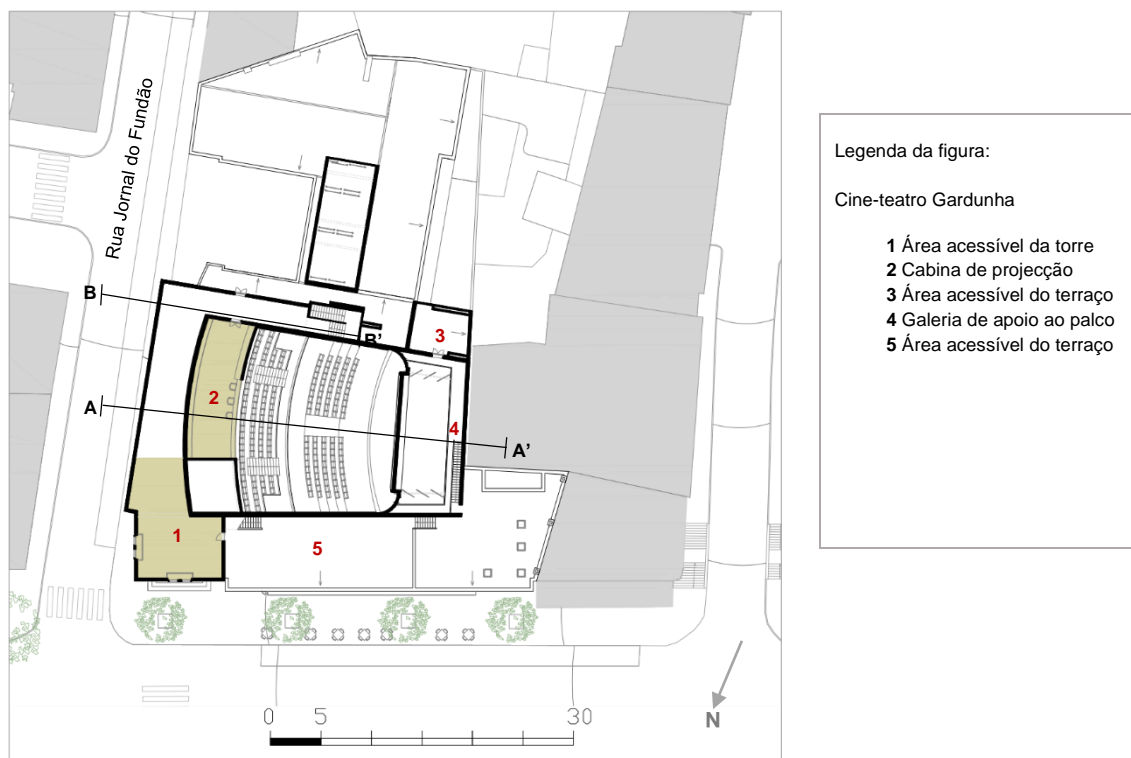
Planta do segundo piso da proposta para o Cine-teatro Gardunha e Academia de Música e Dança do Fundão.
